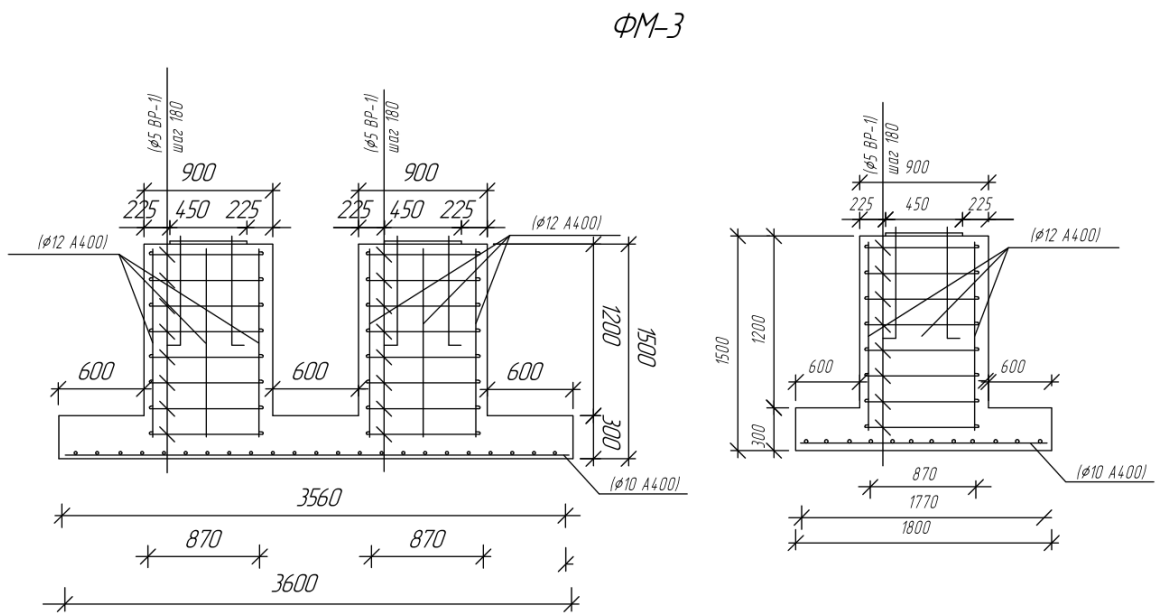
Схема расположения арматурных изделий в фундаментах ФМ3
